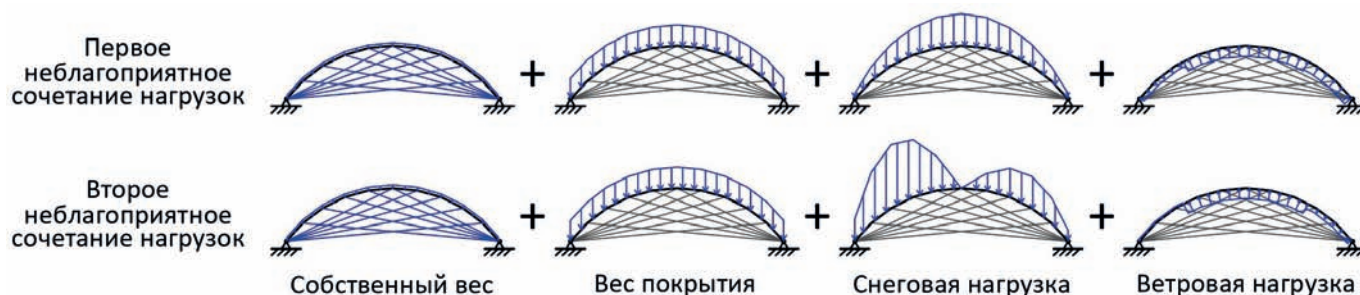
Схема неблагоприятных сочетаний нагрузок на примере схемы 10-10 (см. рис. 1)
